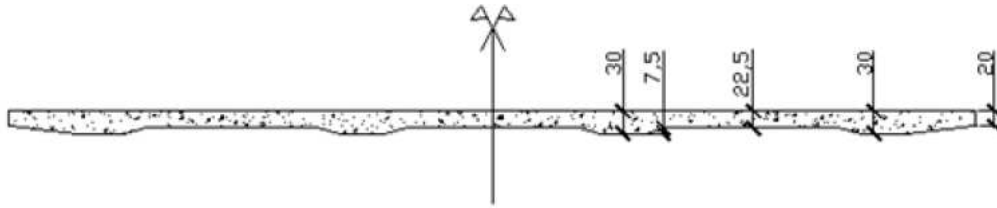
Seção transversal da laje de tabuleiro da ponte em vigas mistas
